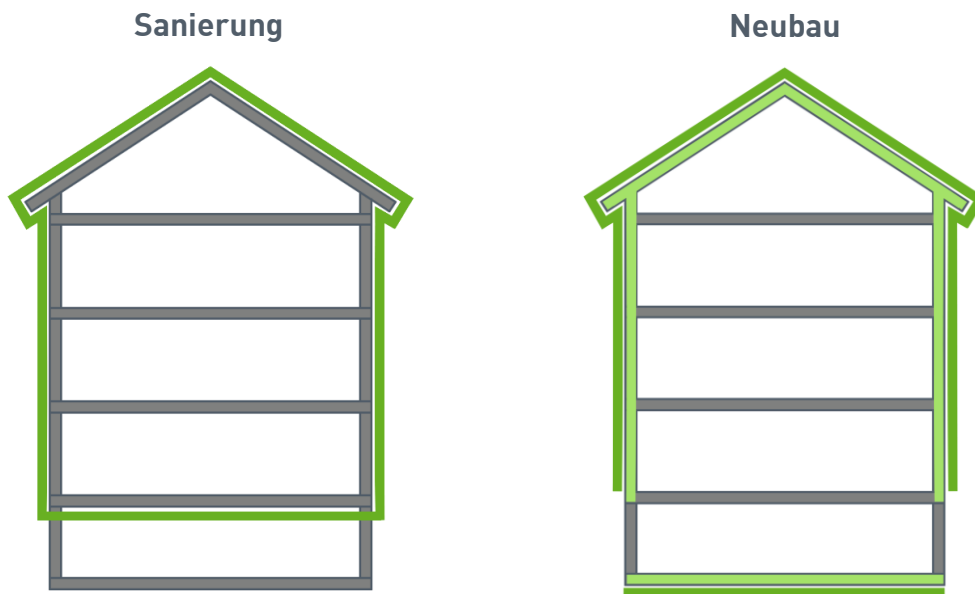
Skizze der modellierten Bauteile bei der Bestandssanierung (links) und dem Neubau (rechts)
